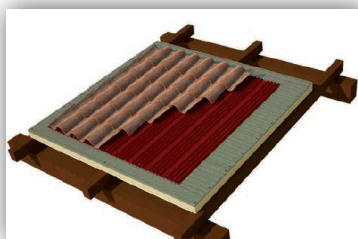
Supuesto de cubierta de la vivienda 2. Fuente Panesandwich
